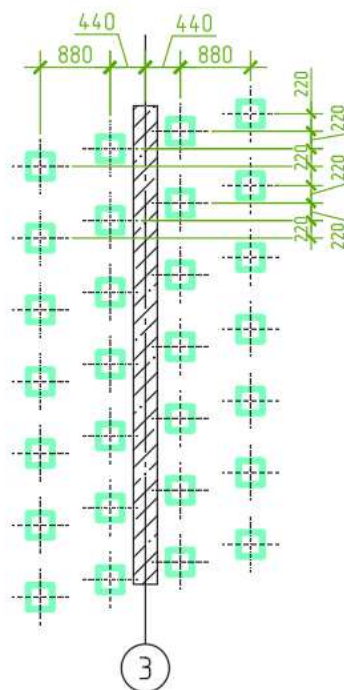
Схема расположения свай под внутреннюю стену
